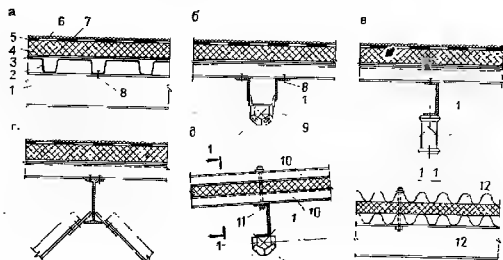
Основные варианты теплой кровли в покрытиях со стержневыми плитами
